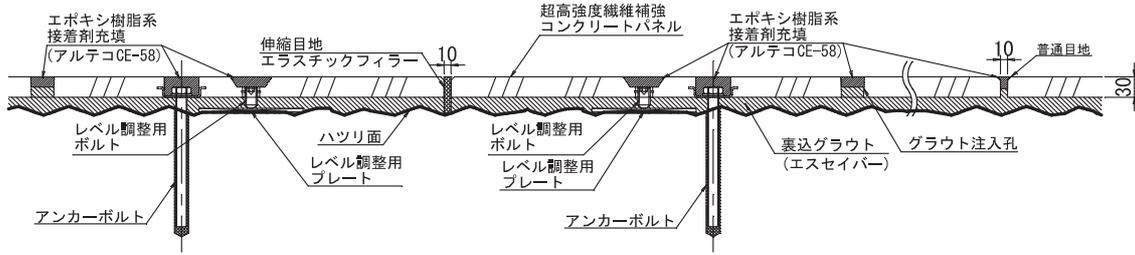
補強工詳細図 (超高強度繊維補強コンクリートパネル)
